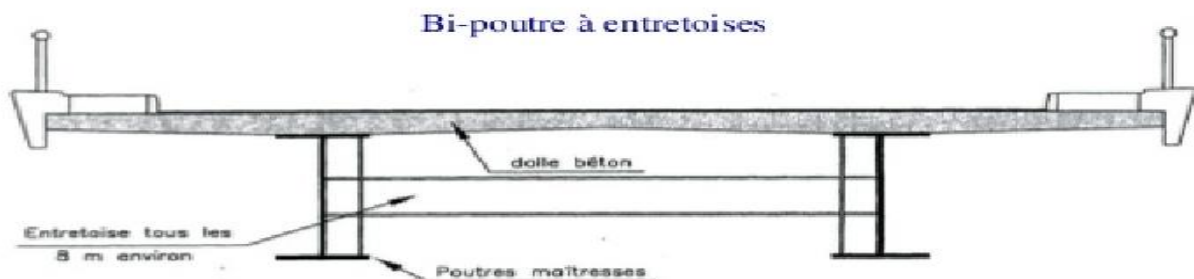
Coupe schématique d'un tablier mixte (bipoutre a entretoise)
